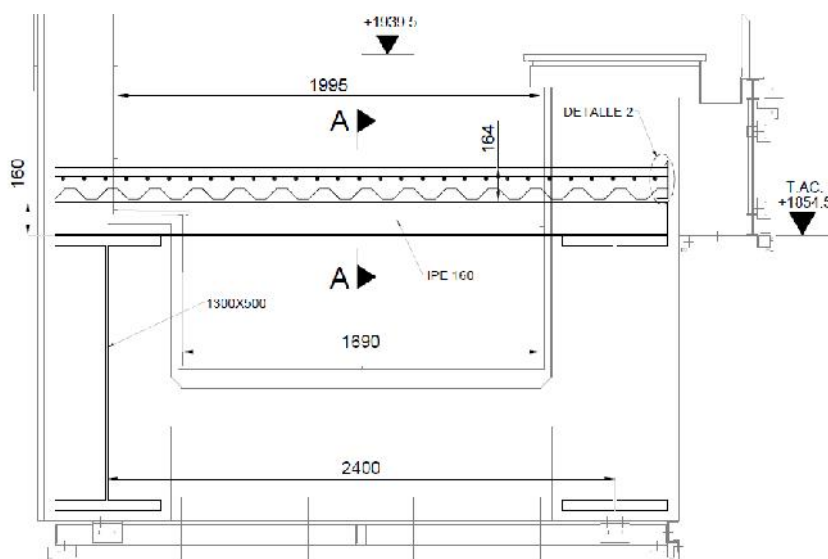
Corte Transversal Losacero apoyada sobre vigas existentes
